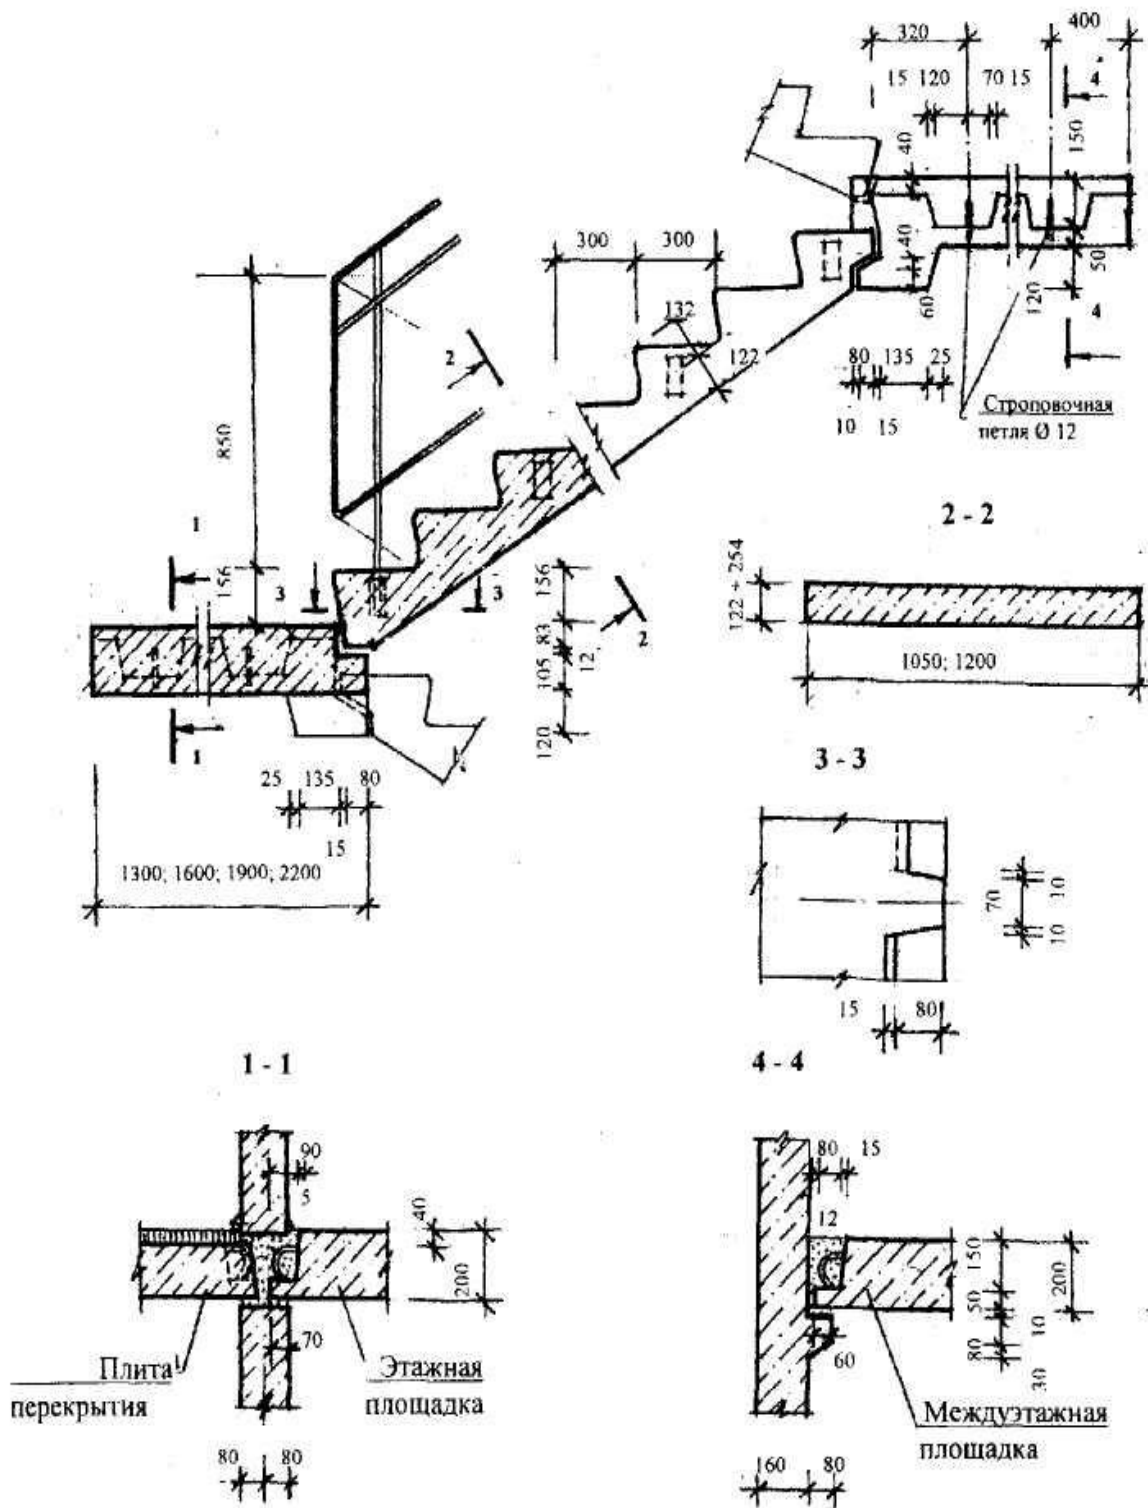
Пример выполнения сечения лестничного марша и лестничной площадки плитной конструкции для высоты этажа 2,8 м
